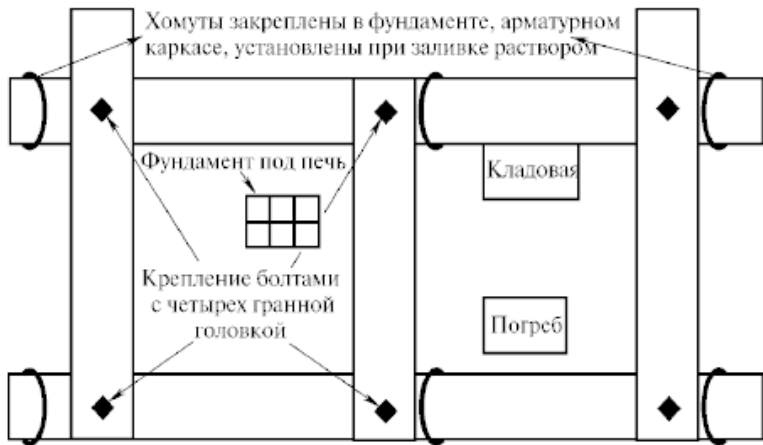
Схема соединения брусьев (или бревен) способом врубки при сооружении деревянного дома (вид сверху) на монолитном ленточном фундаменте
